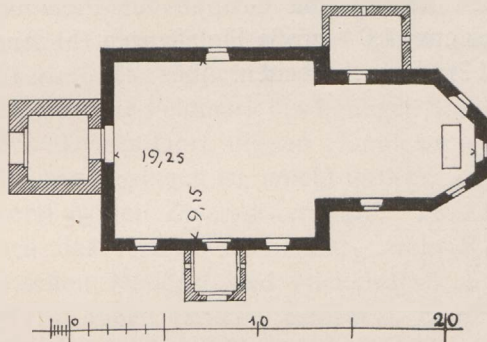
Grundriß der Kirche zu Straszewo. M. 1 : 400.
